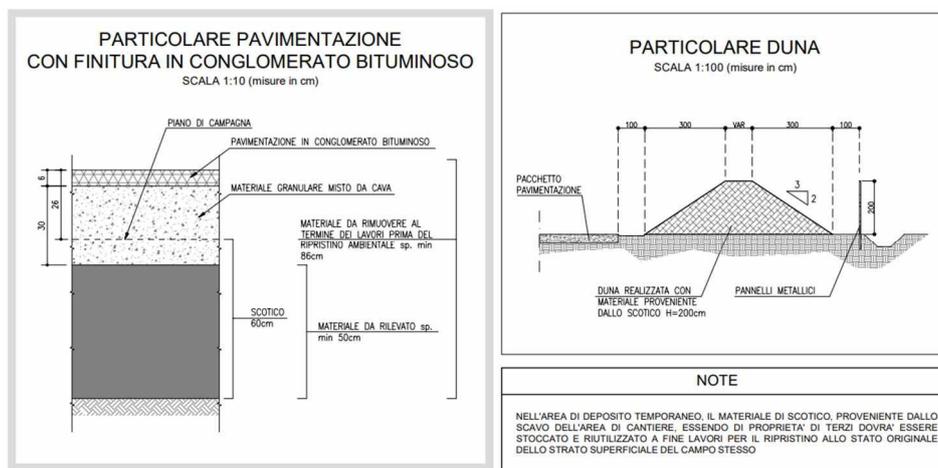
Particolare della duna perimetrale e della pavimentazione
